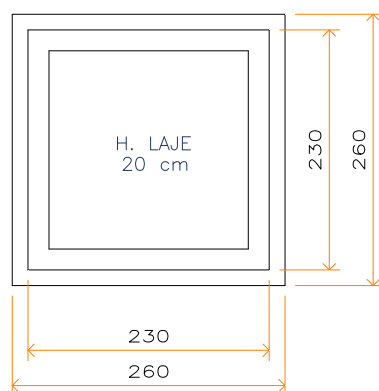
Corte genérico da seção transversal do Poço de Visita em Concreto (PP-4)
